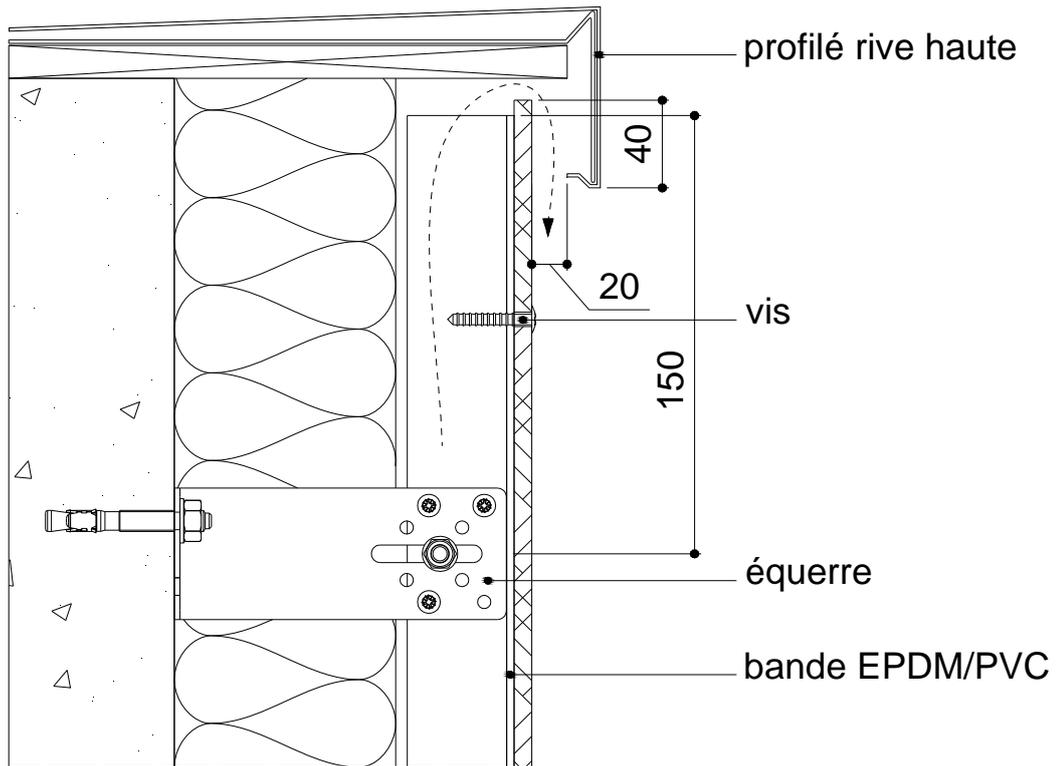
Détail arrêt sur acrotère sur ossature bois (cote en mm)
